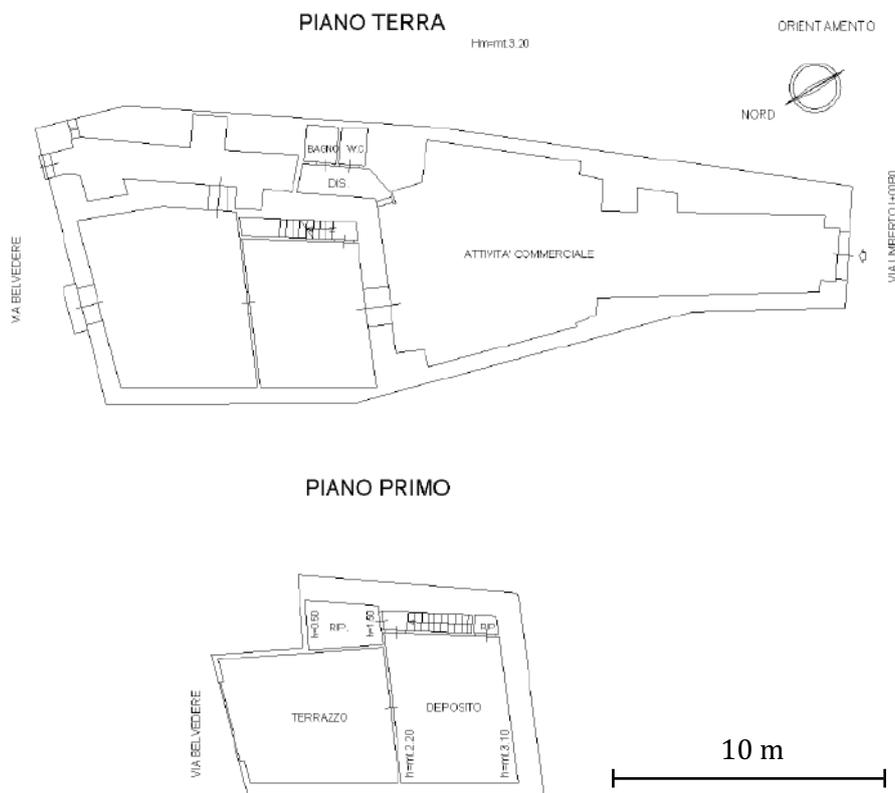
Estratto Planimetria Catastale – Locale commerciale Foglio 19, Part. 790, Sub 6 (ex sub. 3)
